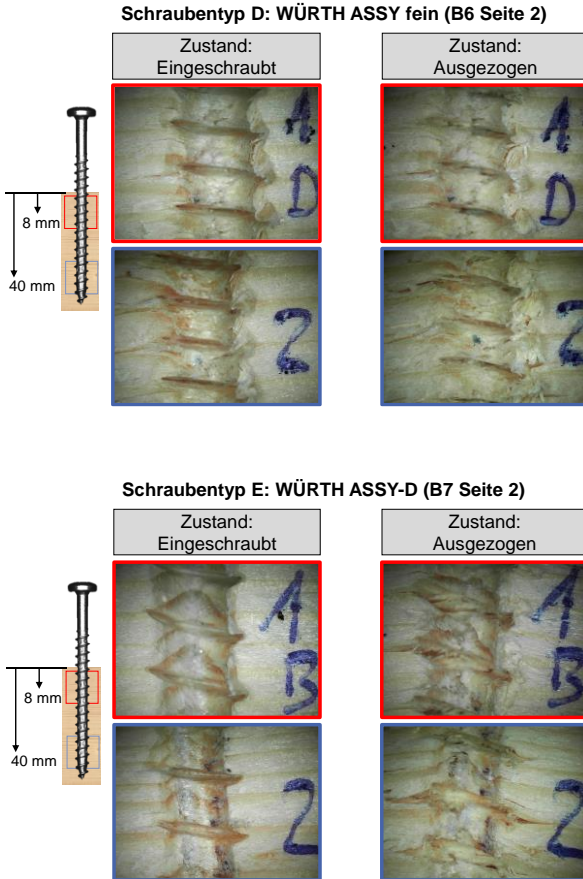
Gewindekontakt der Schraubentypen D und E der Analysetechnik *Sectional Imaging*.
